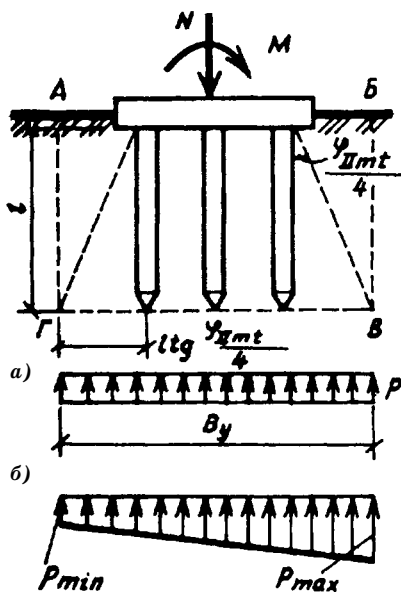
Расчетная схема свайного фундамента из висячих свай:
